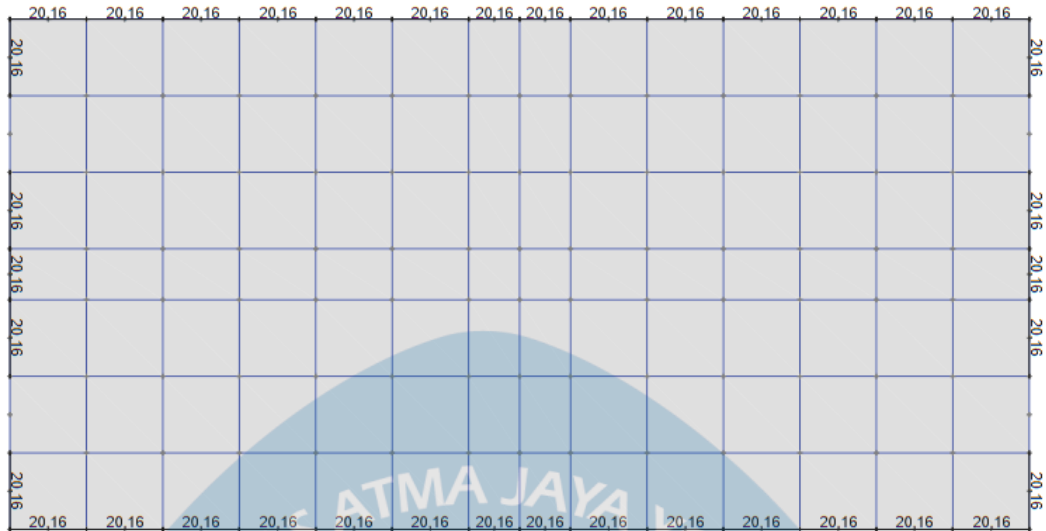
Pembebanan beban hidup *slab* lantai parkir
